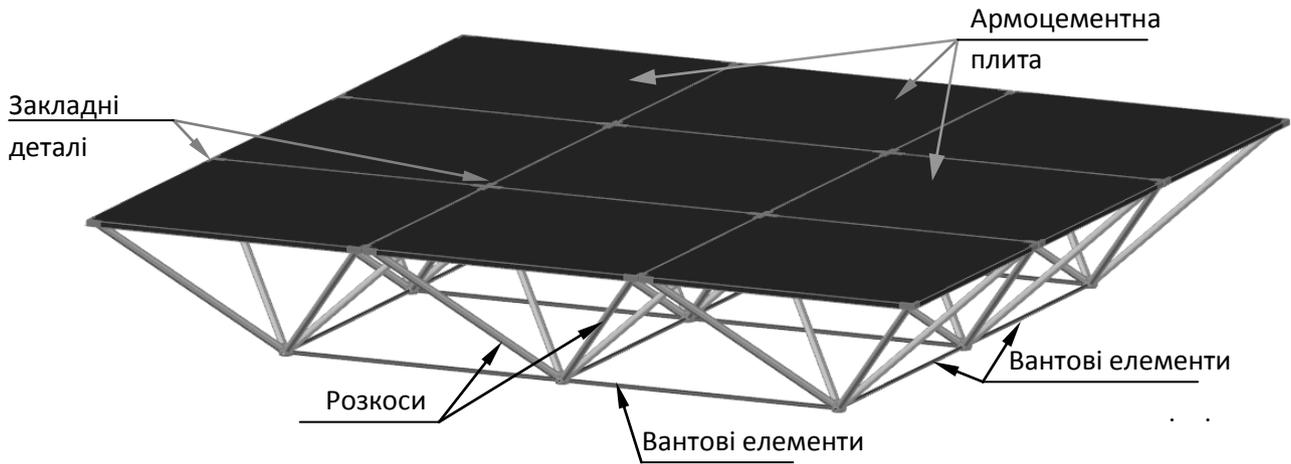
Фрагмент схеми покриття з гнучкими вантами
